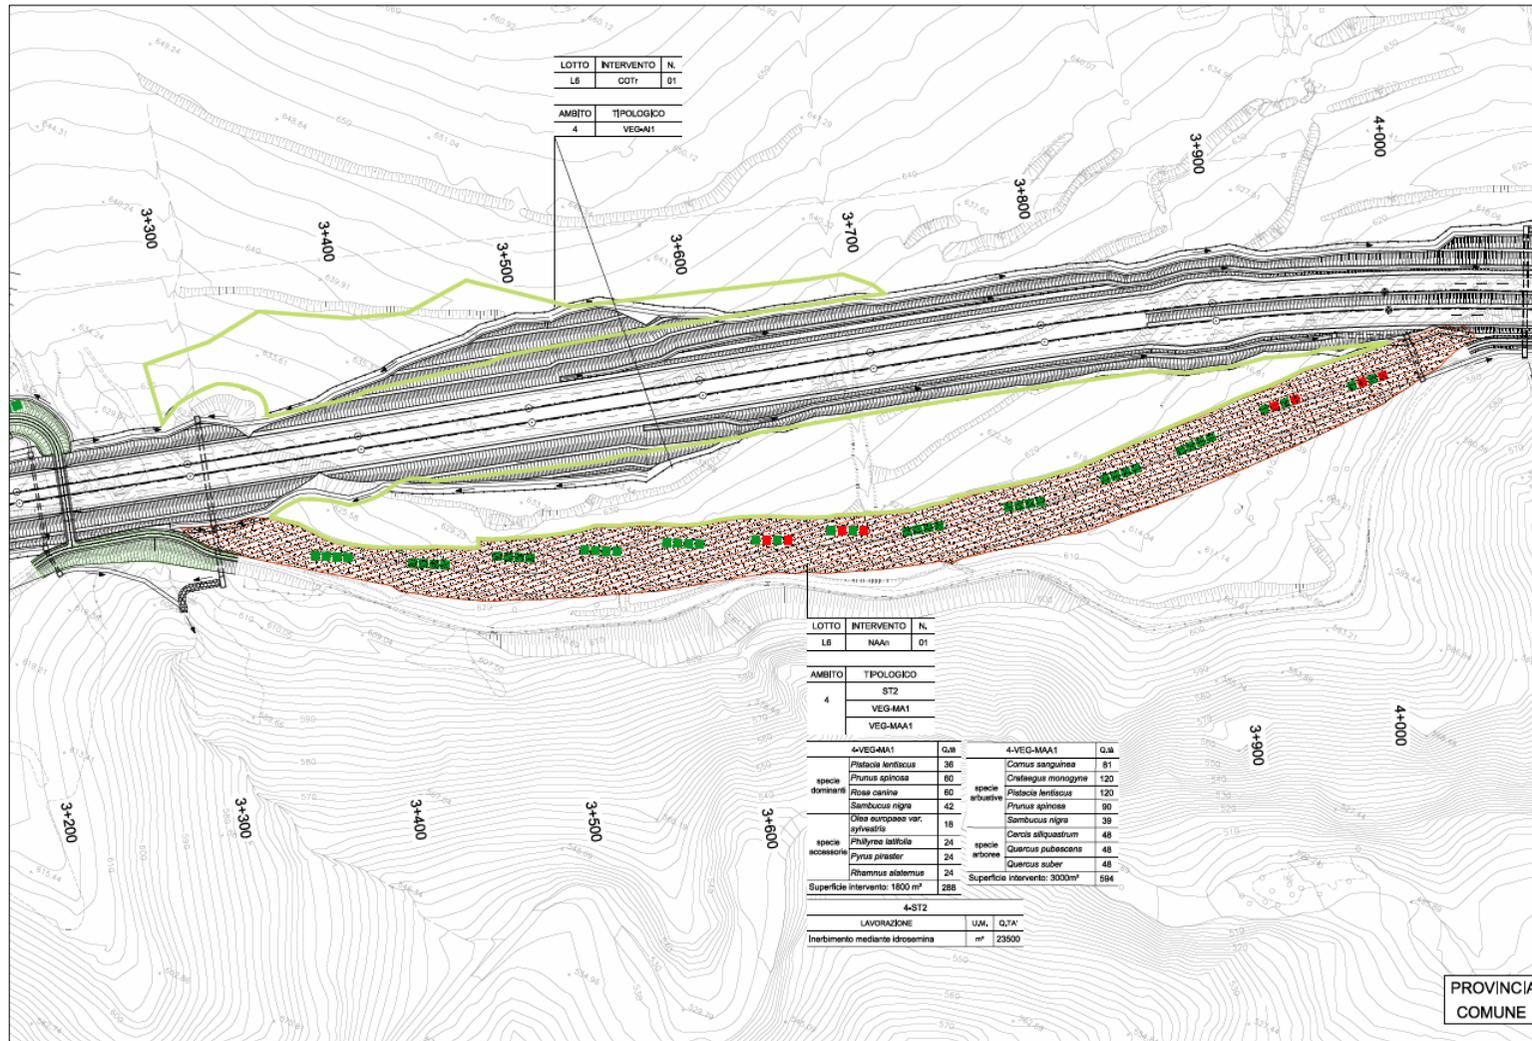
Stralcio planimetrico dell'intervento di naturalizzazione dell'area degradata del Lotto 6 km 3+300 a km 4+000
